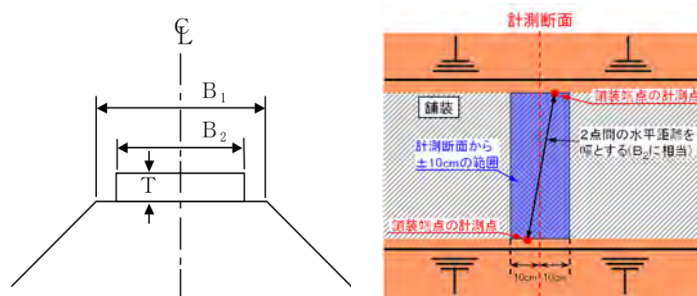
出来形測定箇所標準図（左：横断面図、右：平面図）
